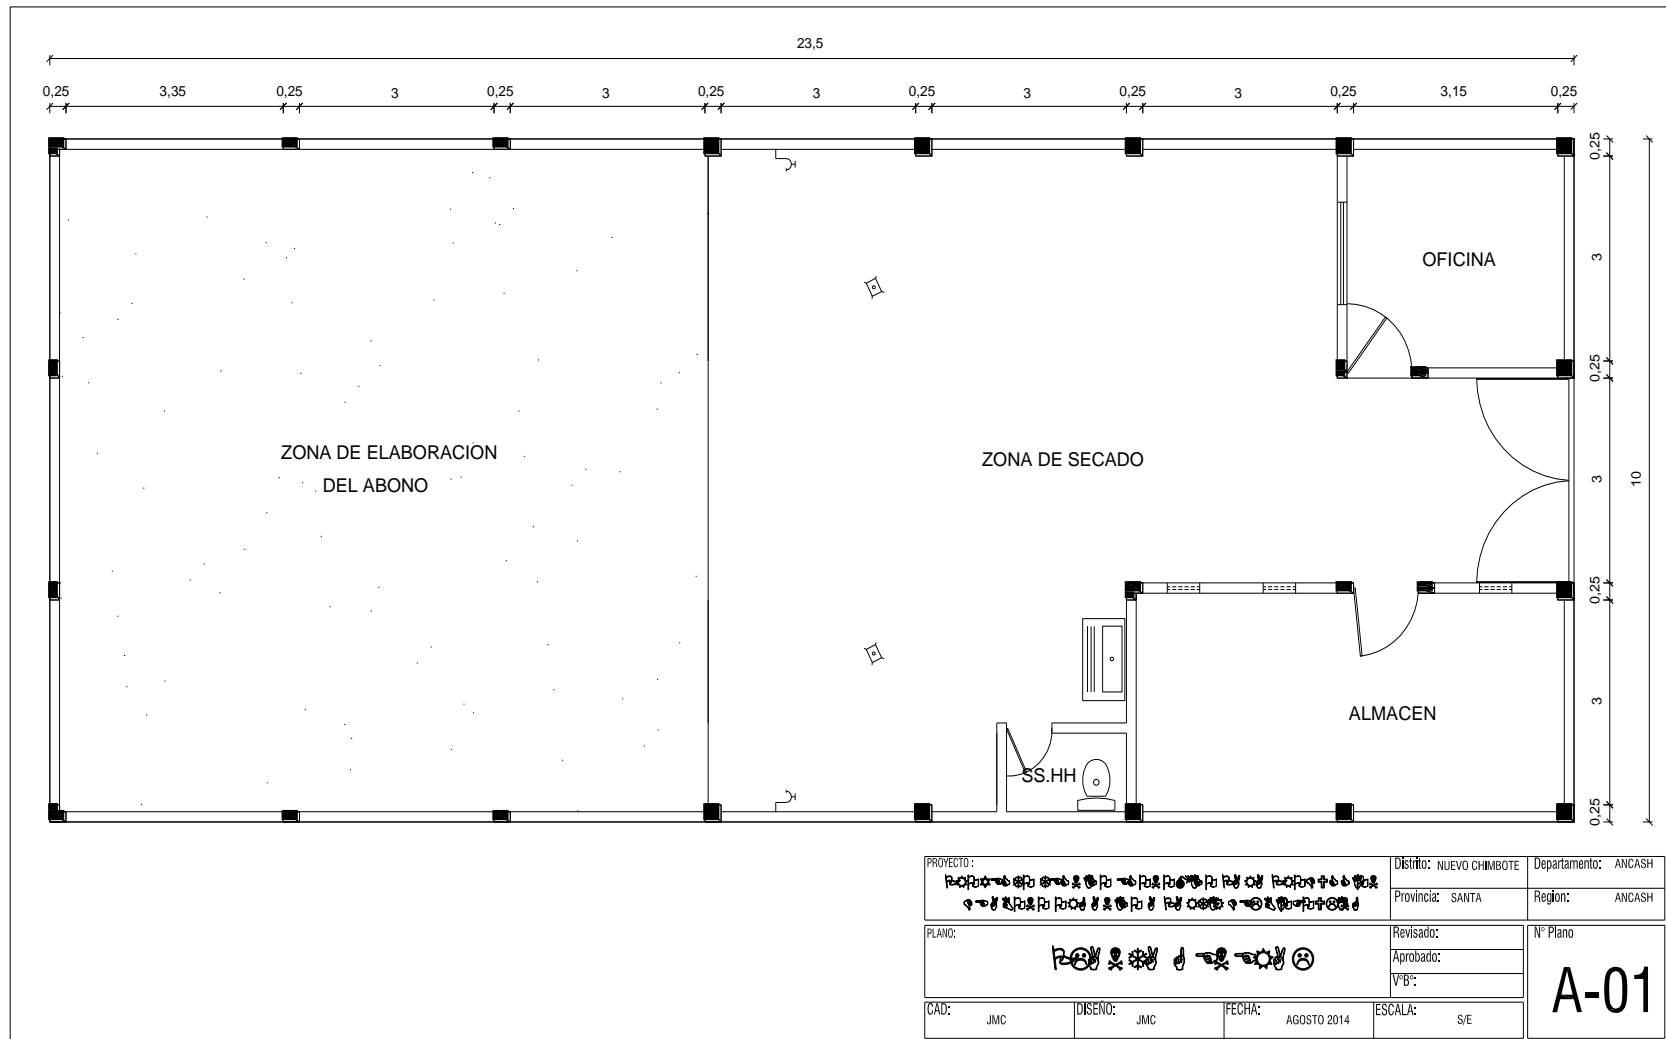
VISTA GENERAL DE PLANTA DE ABONO ORGANICO A PARTIR DEL BIOFOULING
